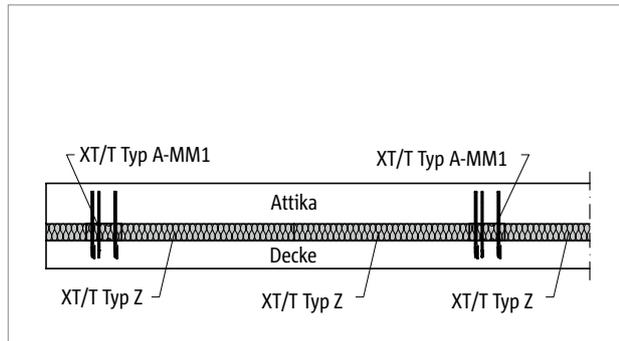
Schöck Isokorb® XT/T Typ A, Z: Attika (XT/T Typ A-MM1)
